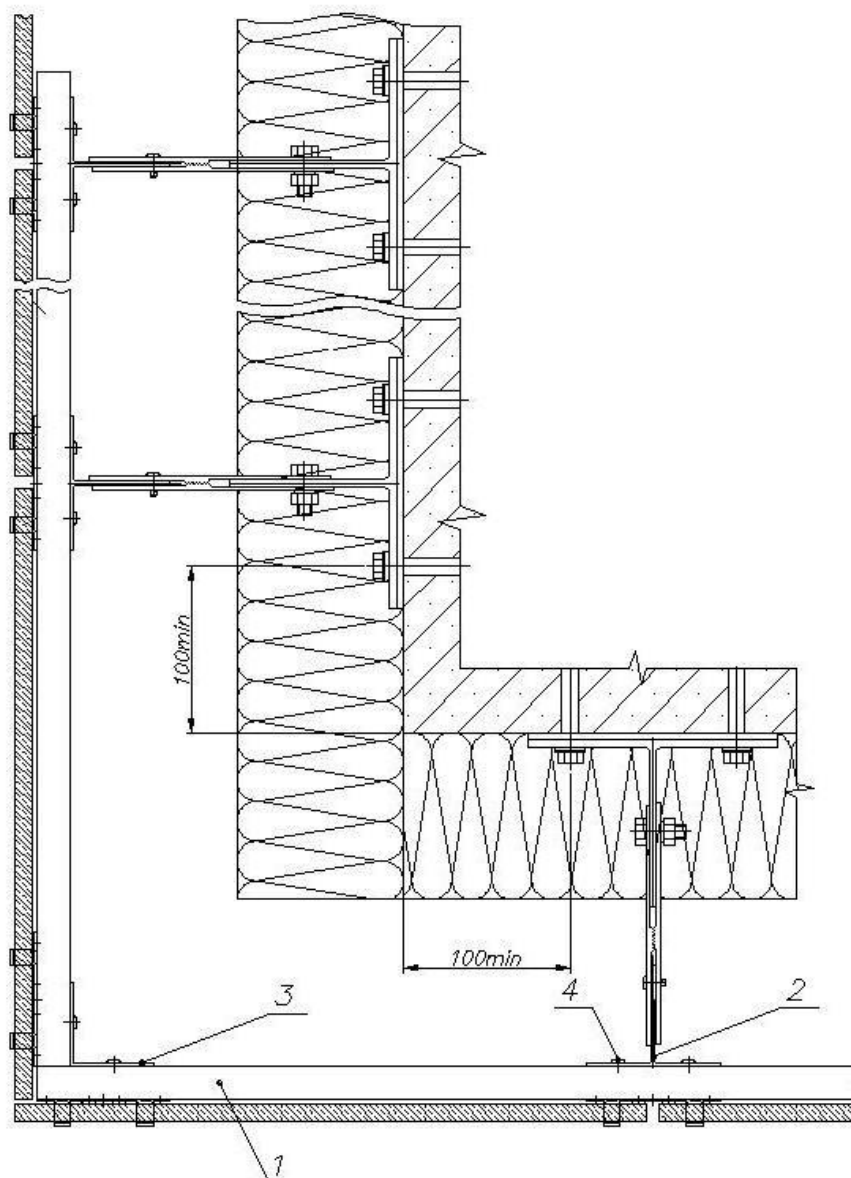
Схема сборки несущей конструкции на наружном углу здания
